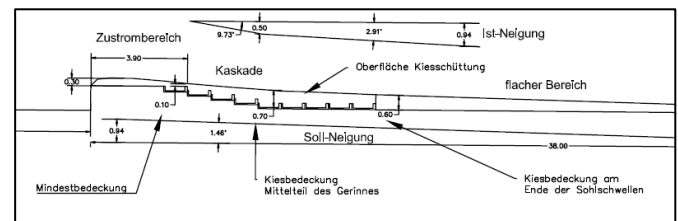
Ausschnitt aus Planzeichnung für den Umbau zur Sohlgleite mit Kiesschüttung
